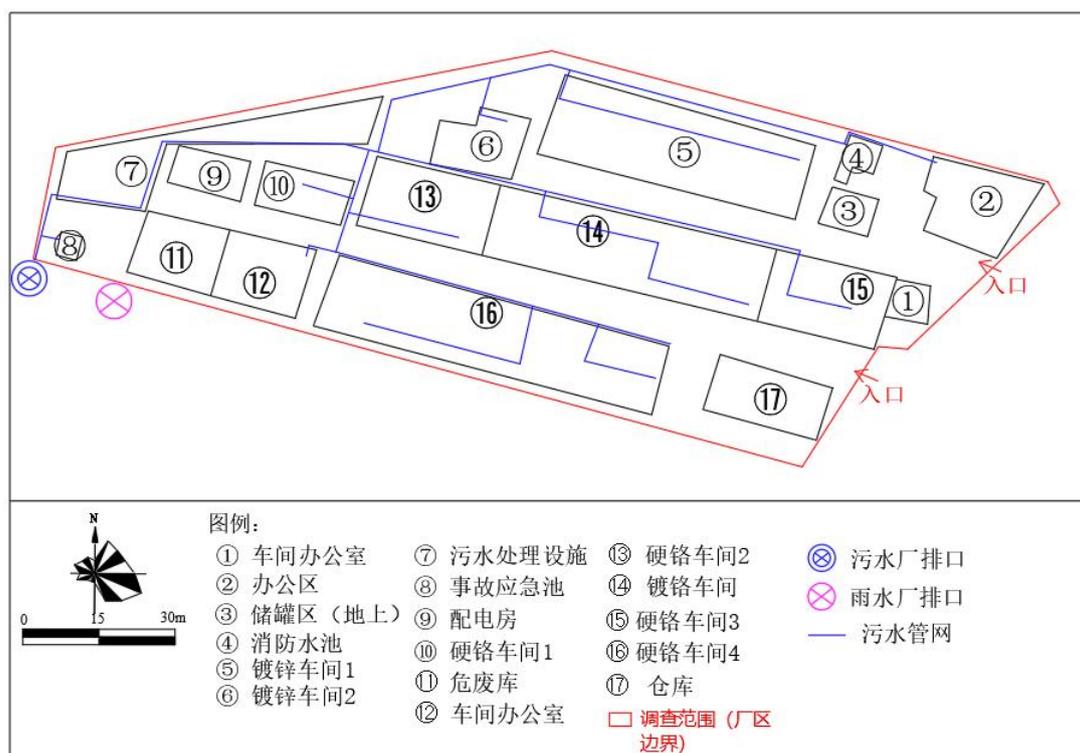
常州市武进庙桥新阳电镀厂平面布置图
